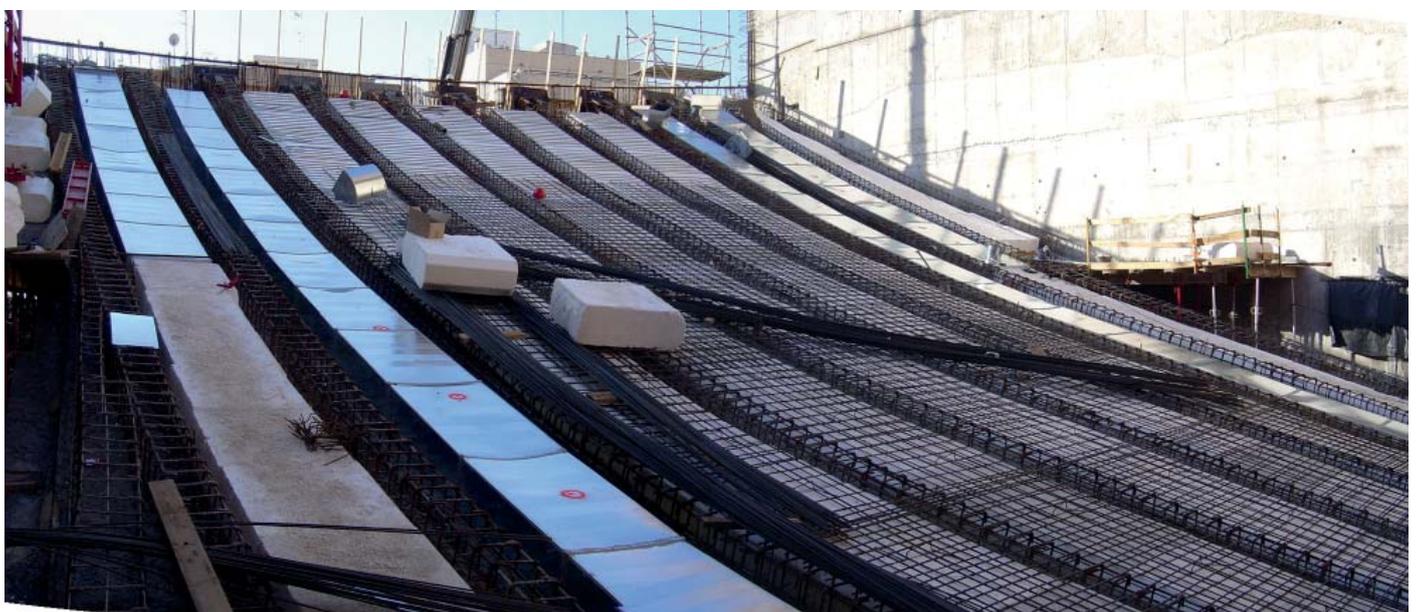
Fotografía de obra de la losa de la platea.
